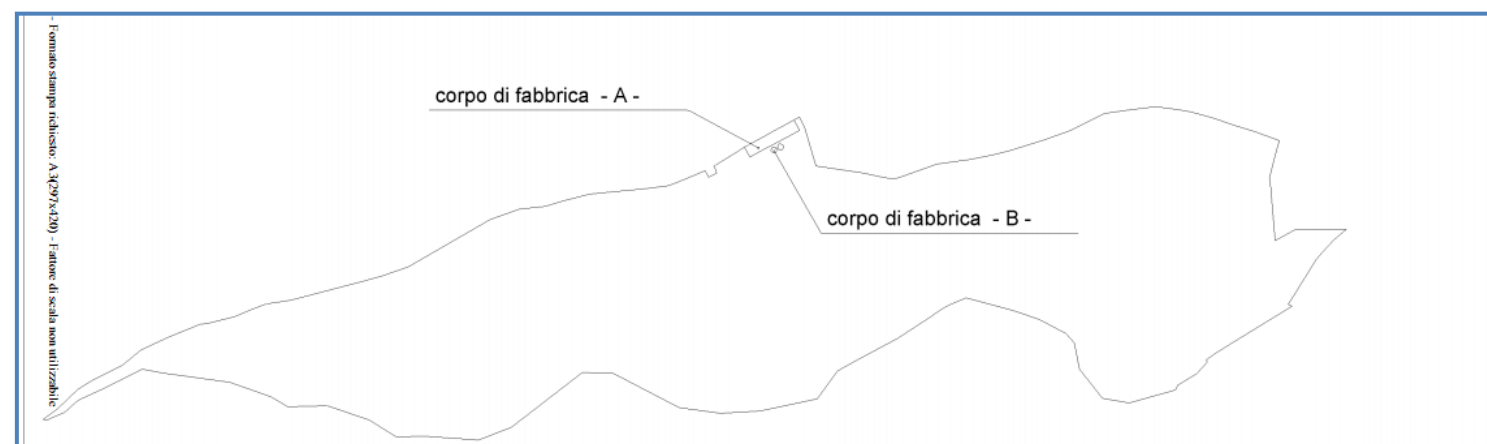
estratto dell'elaborato planimetrico prot. n°CA0136438 del 17/05/2006
